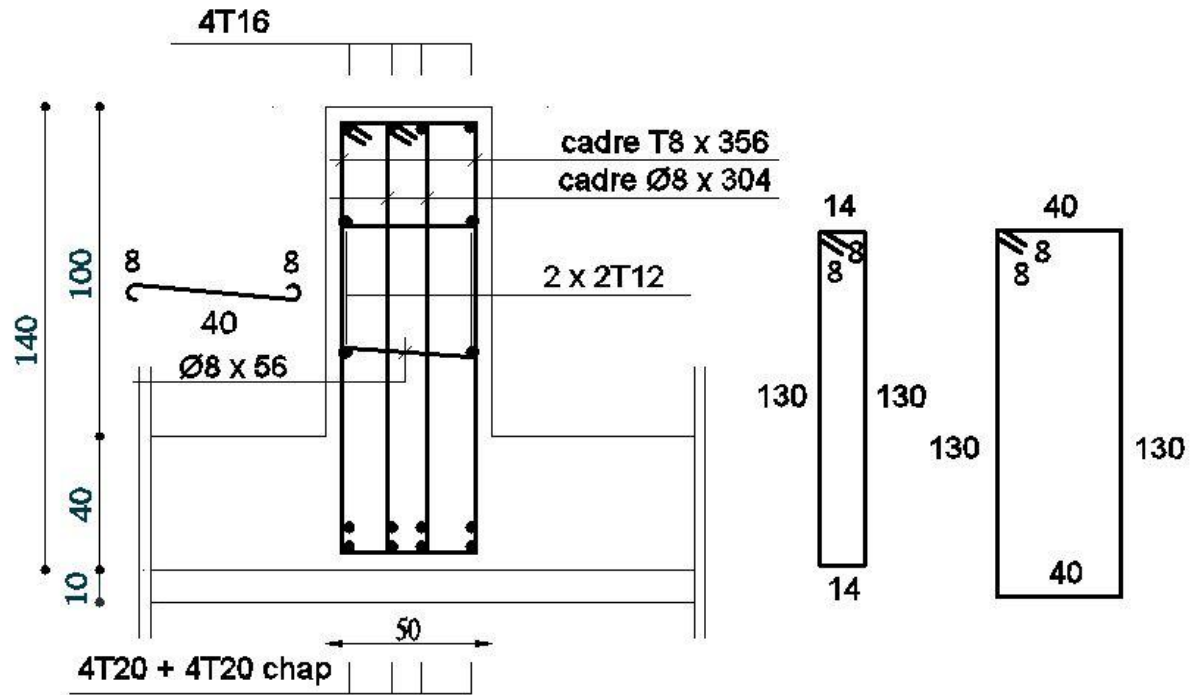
dessin de ferrailage d'une poutre secondaire en appuis..
